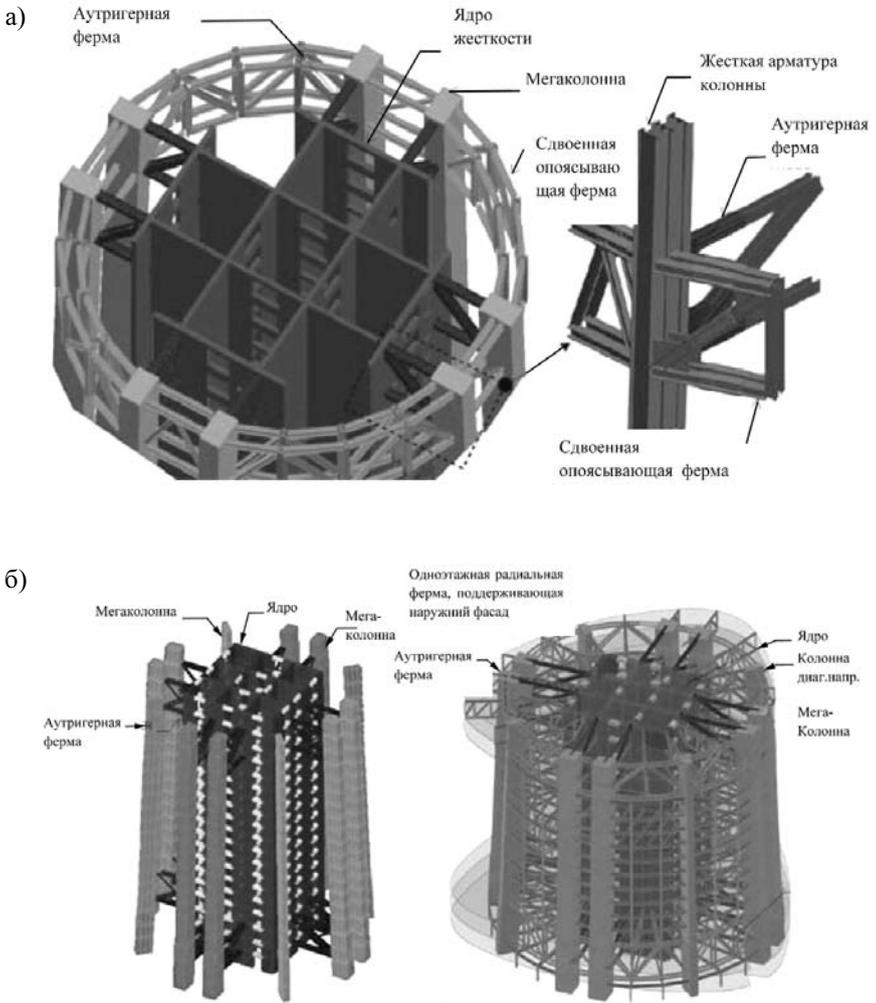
Элементы здания Shanghai Tower: а – детальная схема несущей системы в зоне аутригера, соединение аутригера с мегаколоннами; б – несущая система внизу здания
